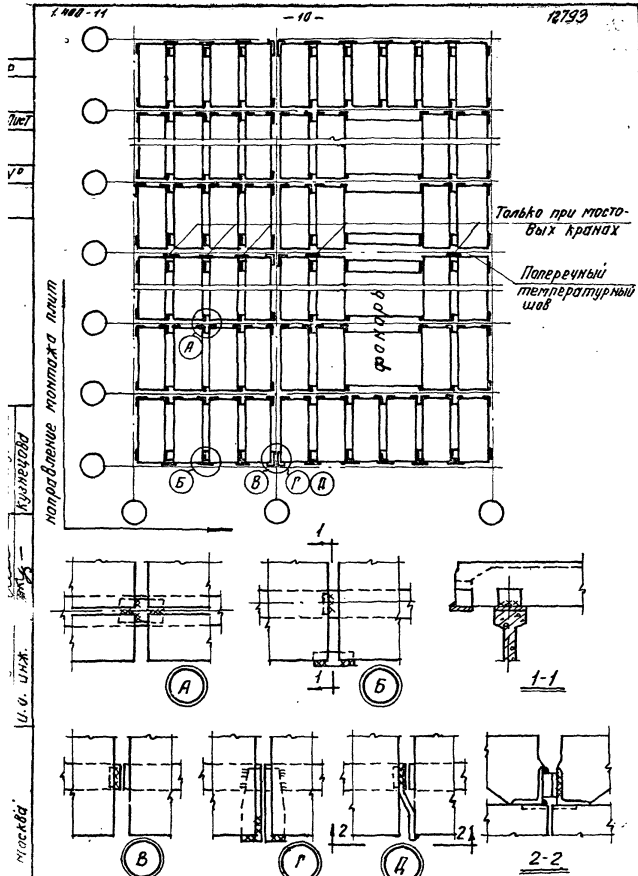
Схема приварки плит при отсутствии подстропильных конструкций
